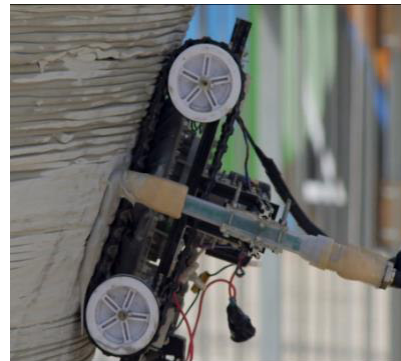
Robô "Vacuum Robot" em processo de impressão. Dimensões de 270x300x120 mm (Stereotactil 2015).
